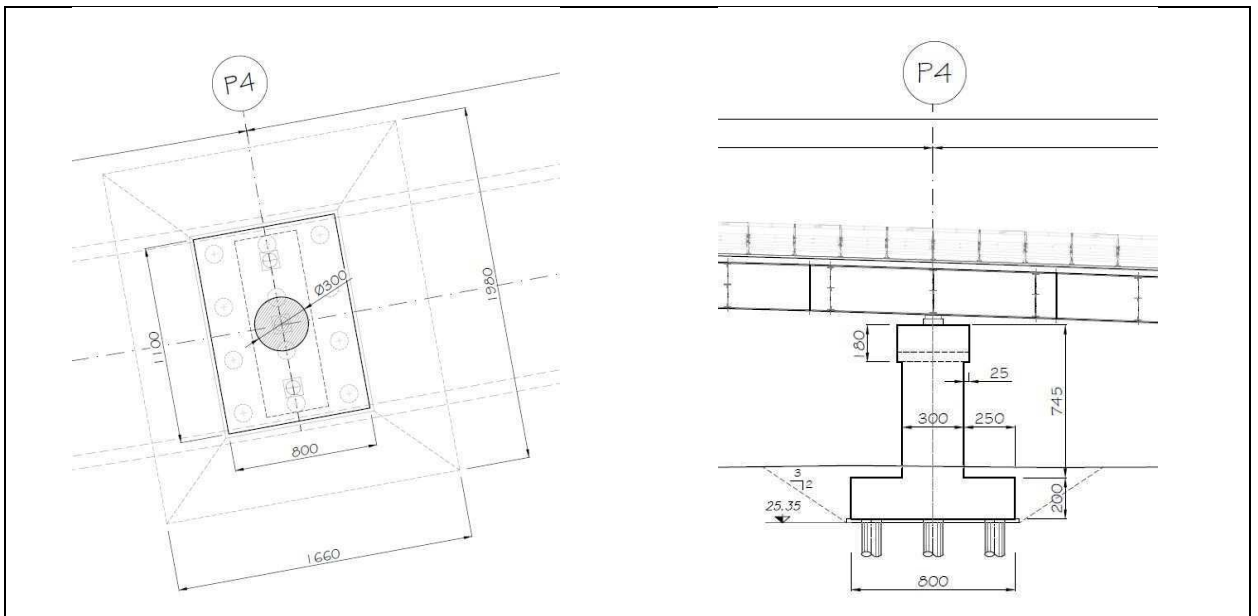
Pila4 – Pianta Fondazioni e Sezione
